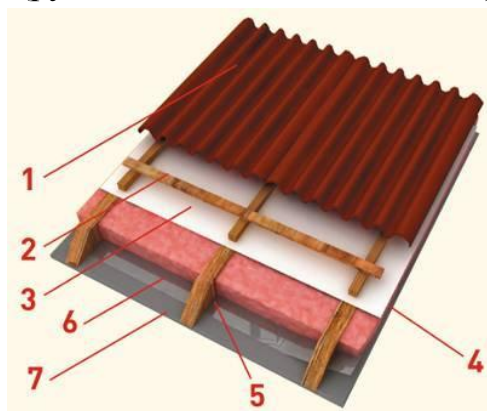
Структура скатной кровли: 1 – черепица или другой кровельный материал; 2 – шаговая (поперечная) обрешетка; 3 – ветро- и влагозащитная мембрана; 4 – слой утеплителя; 5 – стропила; 6 – слой пароизоляции; 7 – слой внутренней отделки
